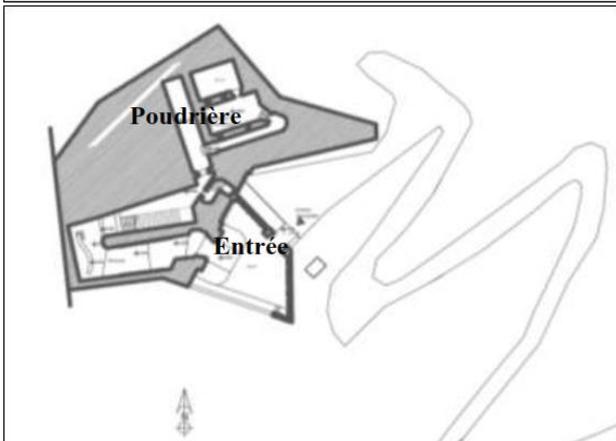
Plan du Premier Niveau du Fort de Santa Cruz
